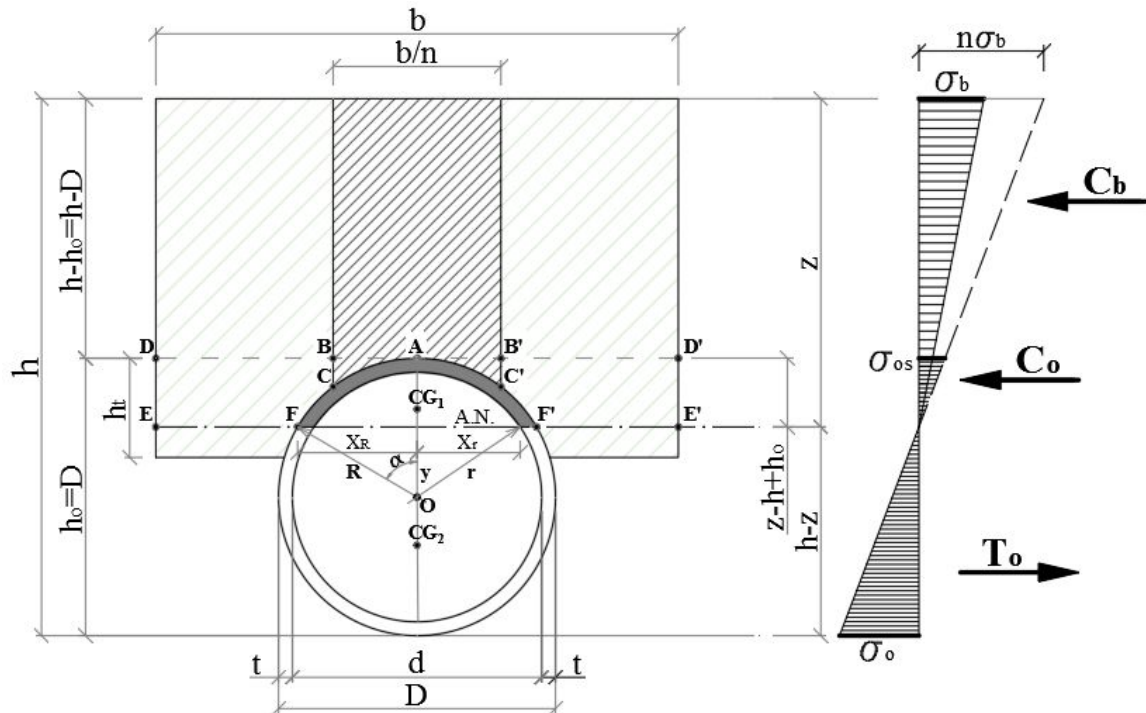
2. Model de calcul pentru structură mixtă oțel-beton cu structura metalică din țevi de oțel tangențiale
